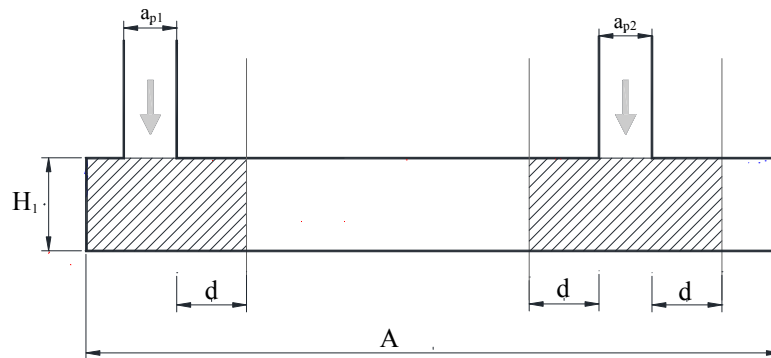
Modelo 5. Cálculo armadura transversal.
